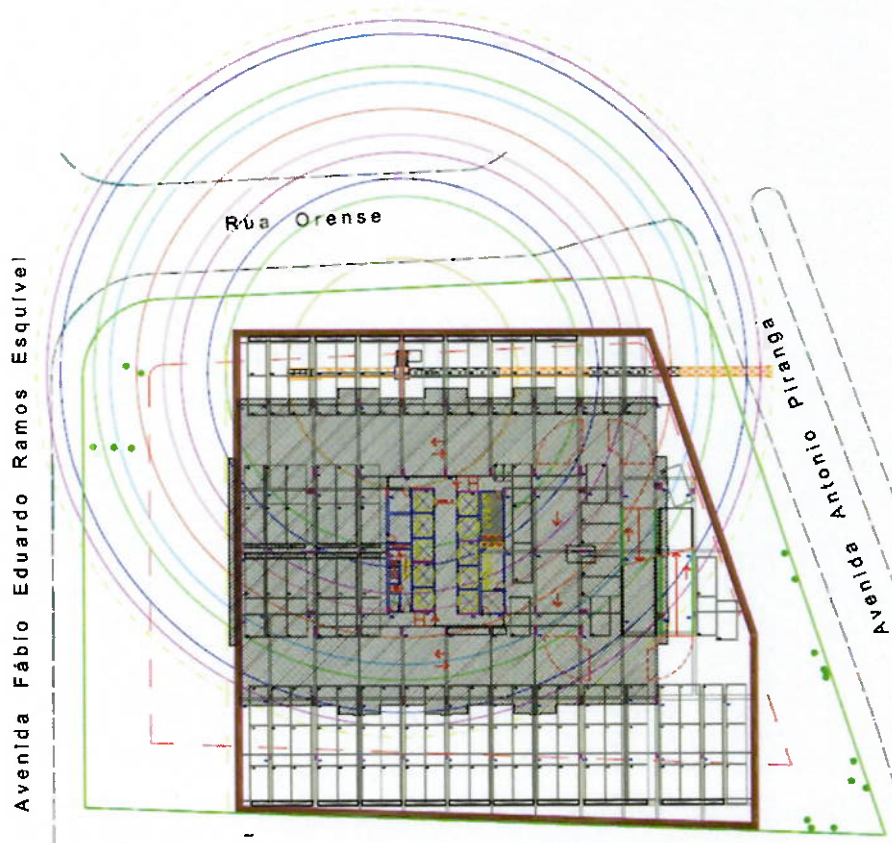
Projeções da lança da grua externa (MC115) – (Fonte: Estrucap)
